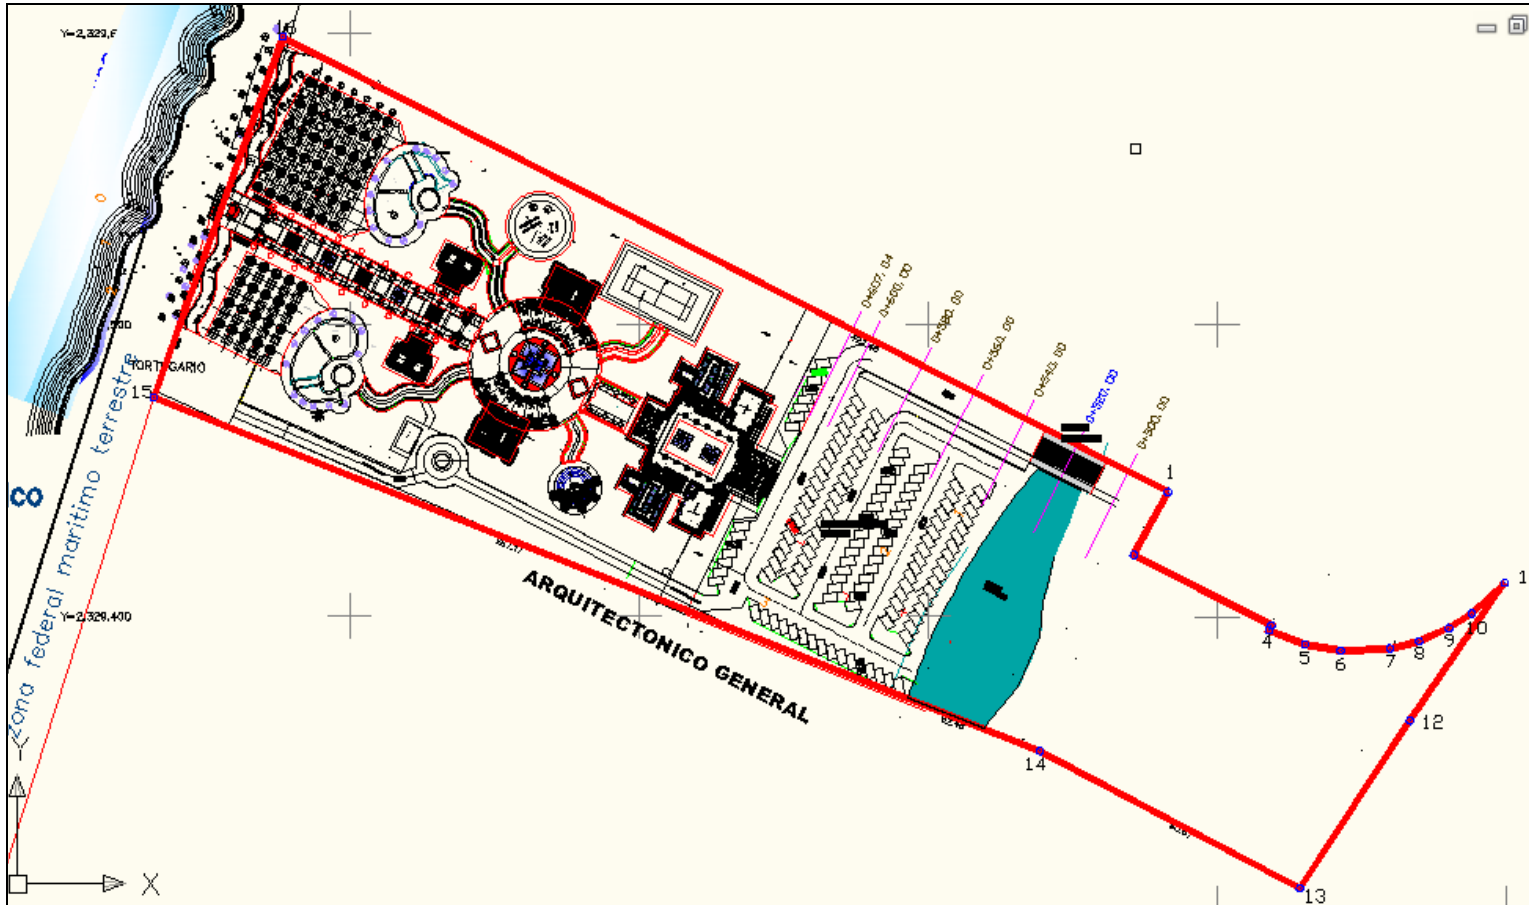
Planta Arquitectónica CLUB DE PLAYA EL PLAYÓN
